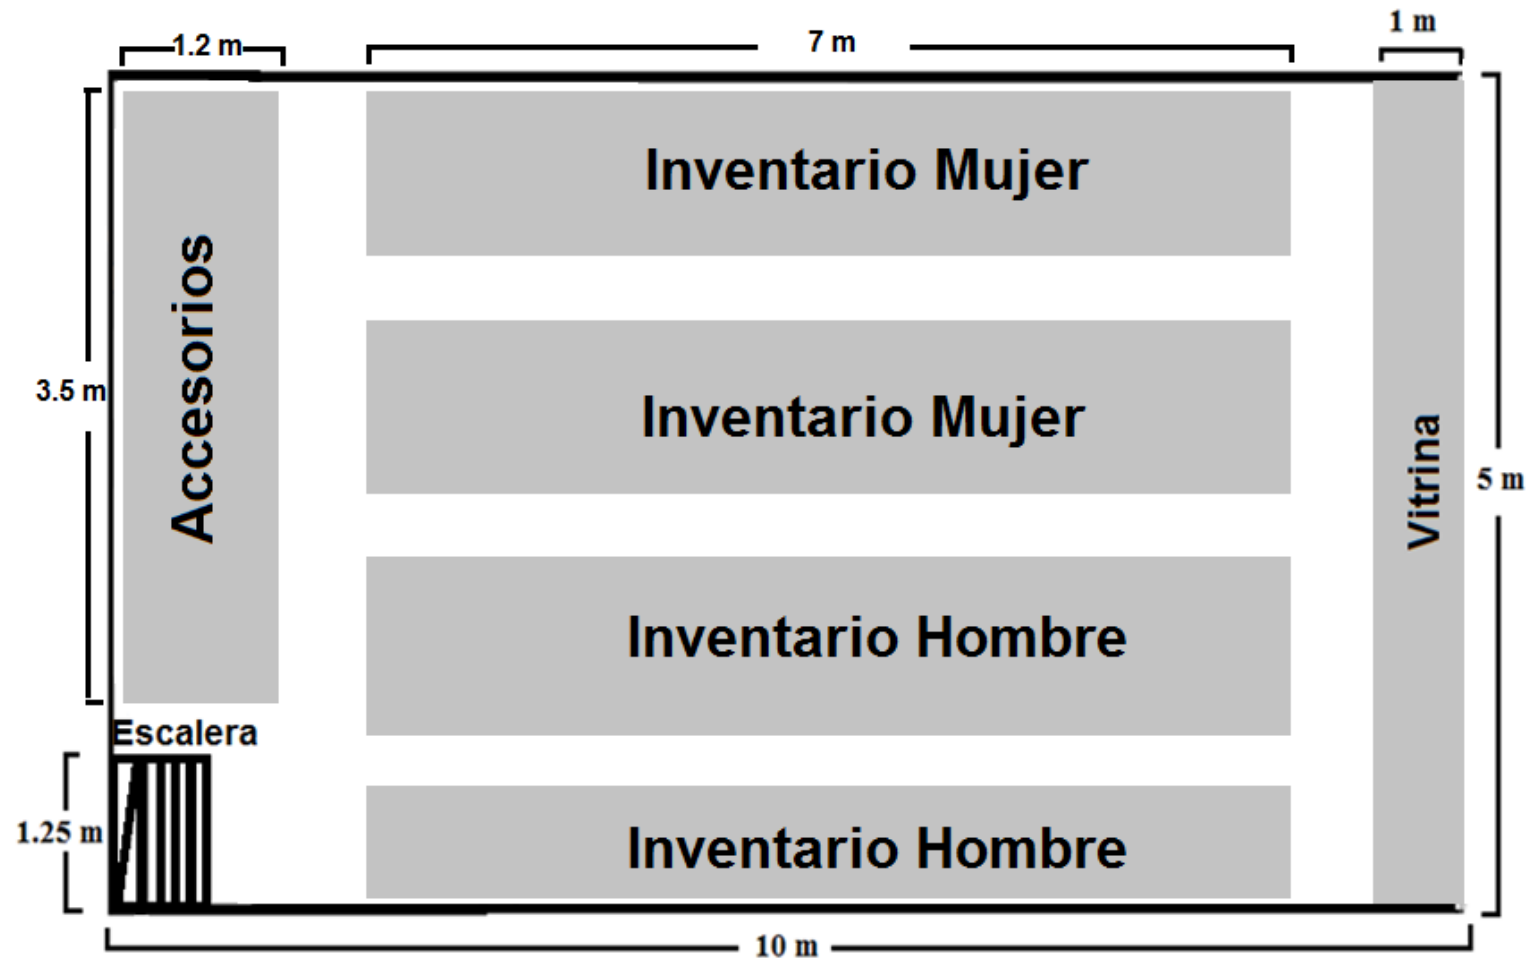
Plano, planta 2 La boutique ESTILO,
